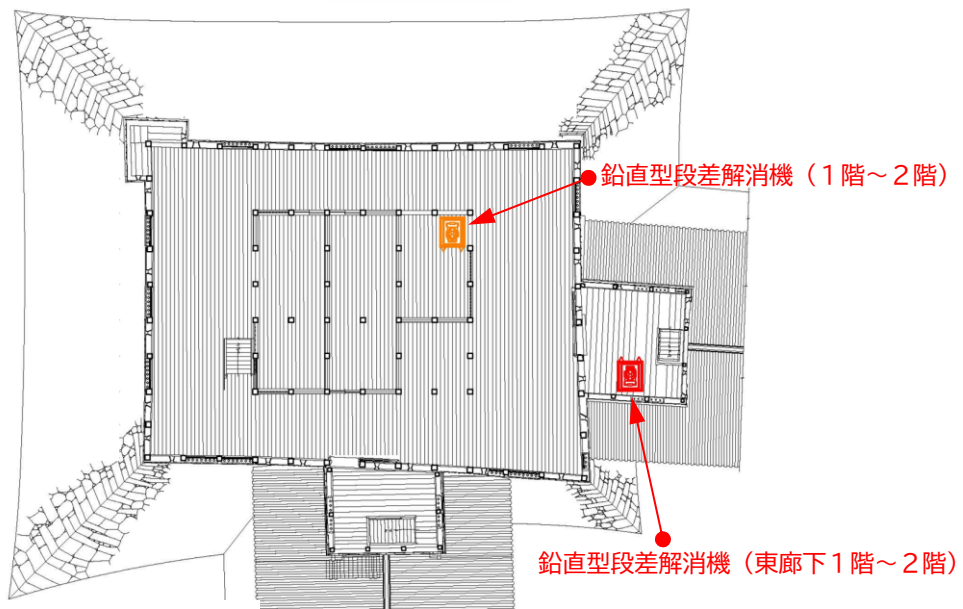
天守1階平面図及び東廊下・南廊下2階平面図（復元原案）
